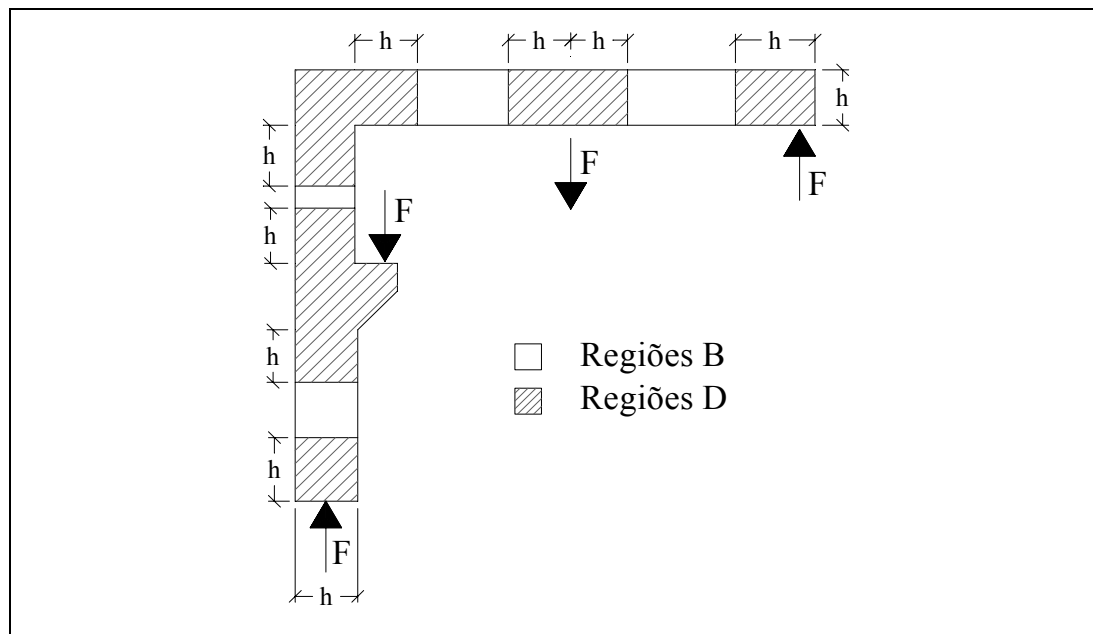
Exemplo de estrutura subdividida em Regiões B e D
